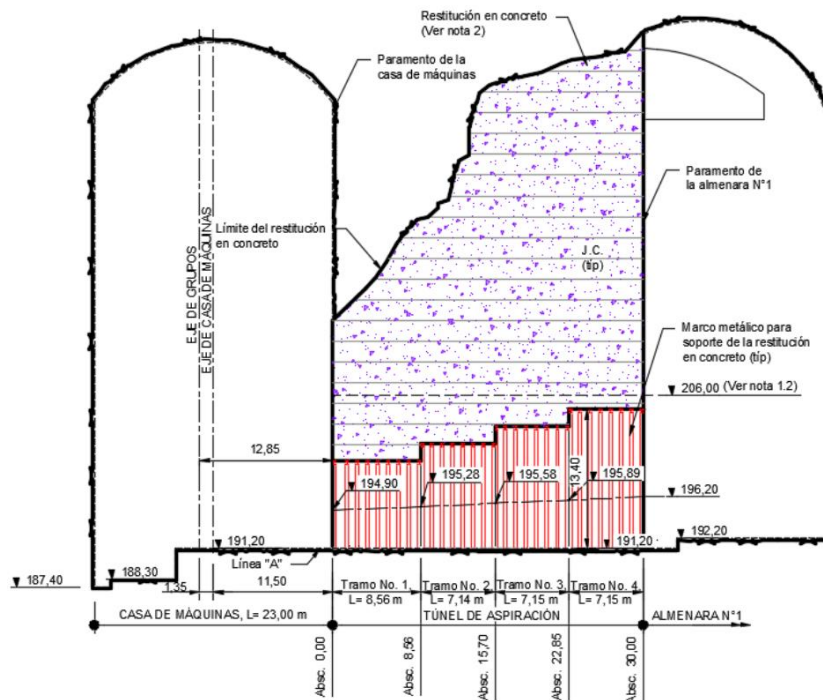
Esquema de reconstrucción del Pilar entre ambas Cavernas
